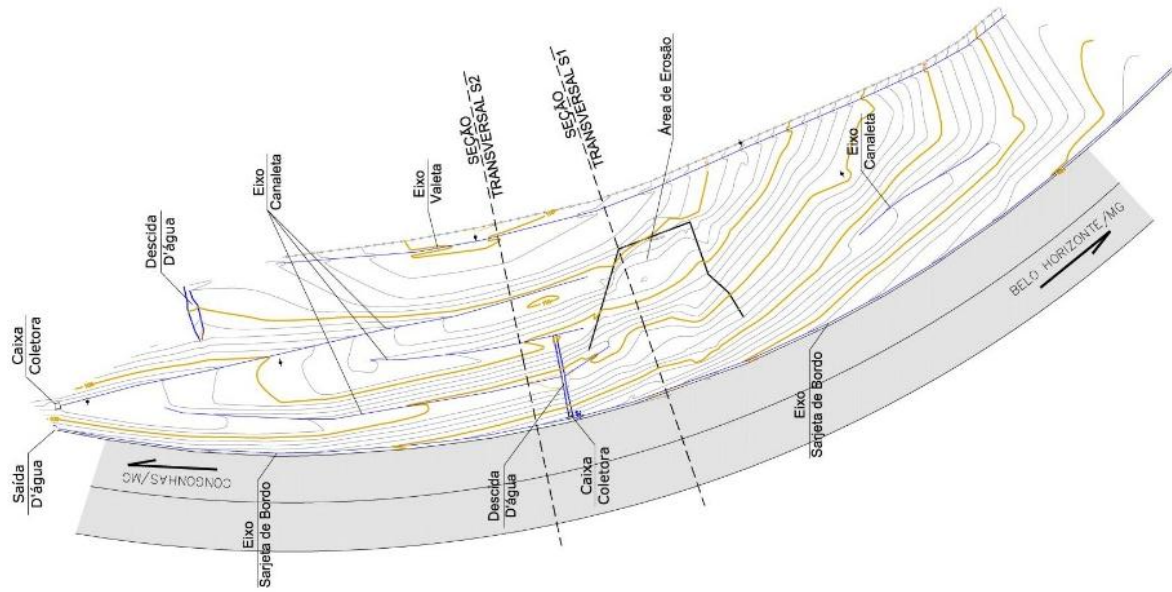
Planta baixa MA02, condição logo após ruptura.
